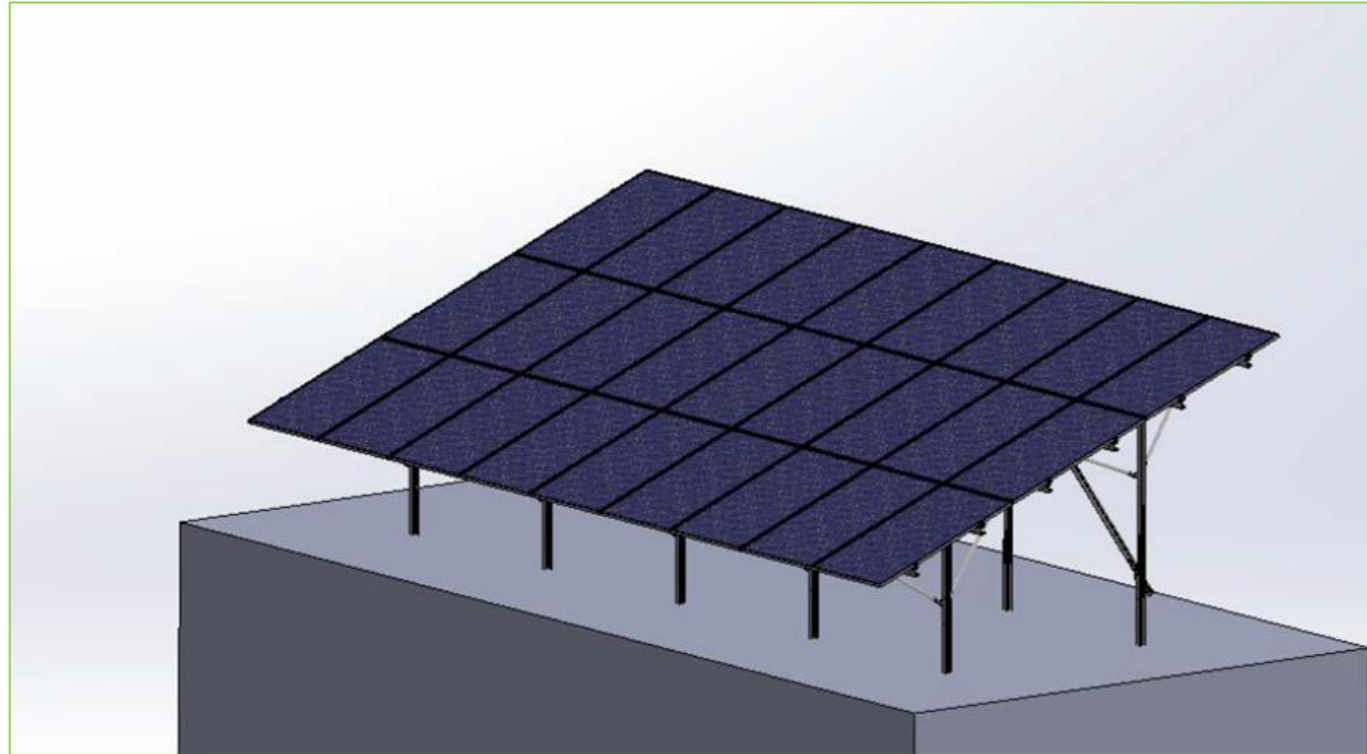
Exemple d'ancrage au sol par pieux vissés ou battus (source : PHOTOSOL)
